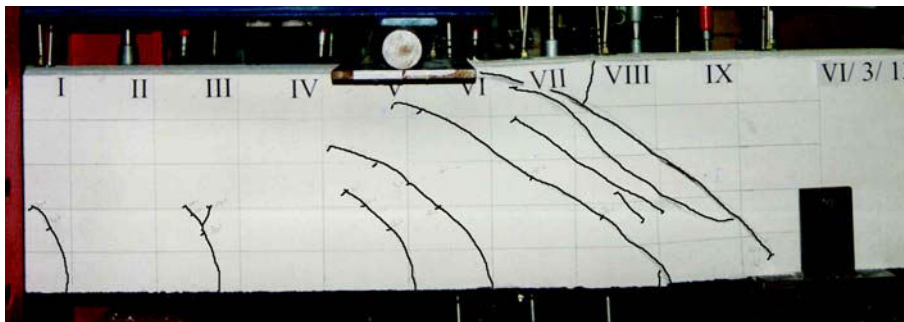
Bruchbild des Versuchsbalkens VI/3/13/1B_3 mit einer Viertelpunktlast
